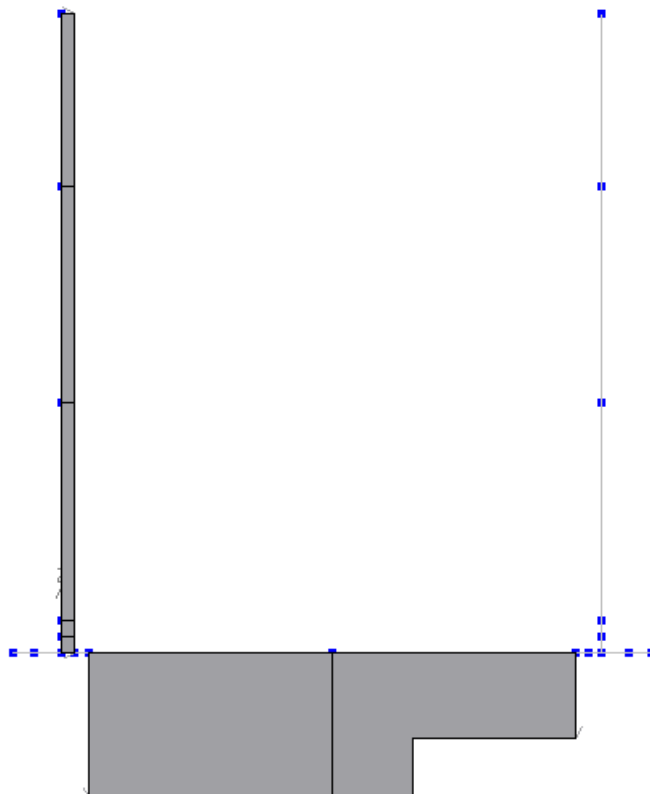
SPINTA DEL SOVRACCARICO 20 kN/M2 SUL PIEDRITTO SINISTRO E SOVRACCARICO ACCIDENTALE SULLA SOLETTA DI FONDAZIONE (CDC 12)
